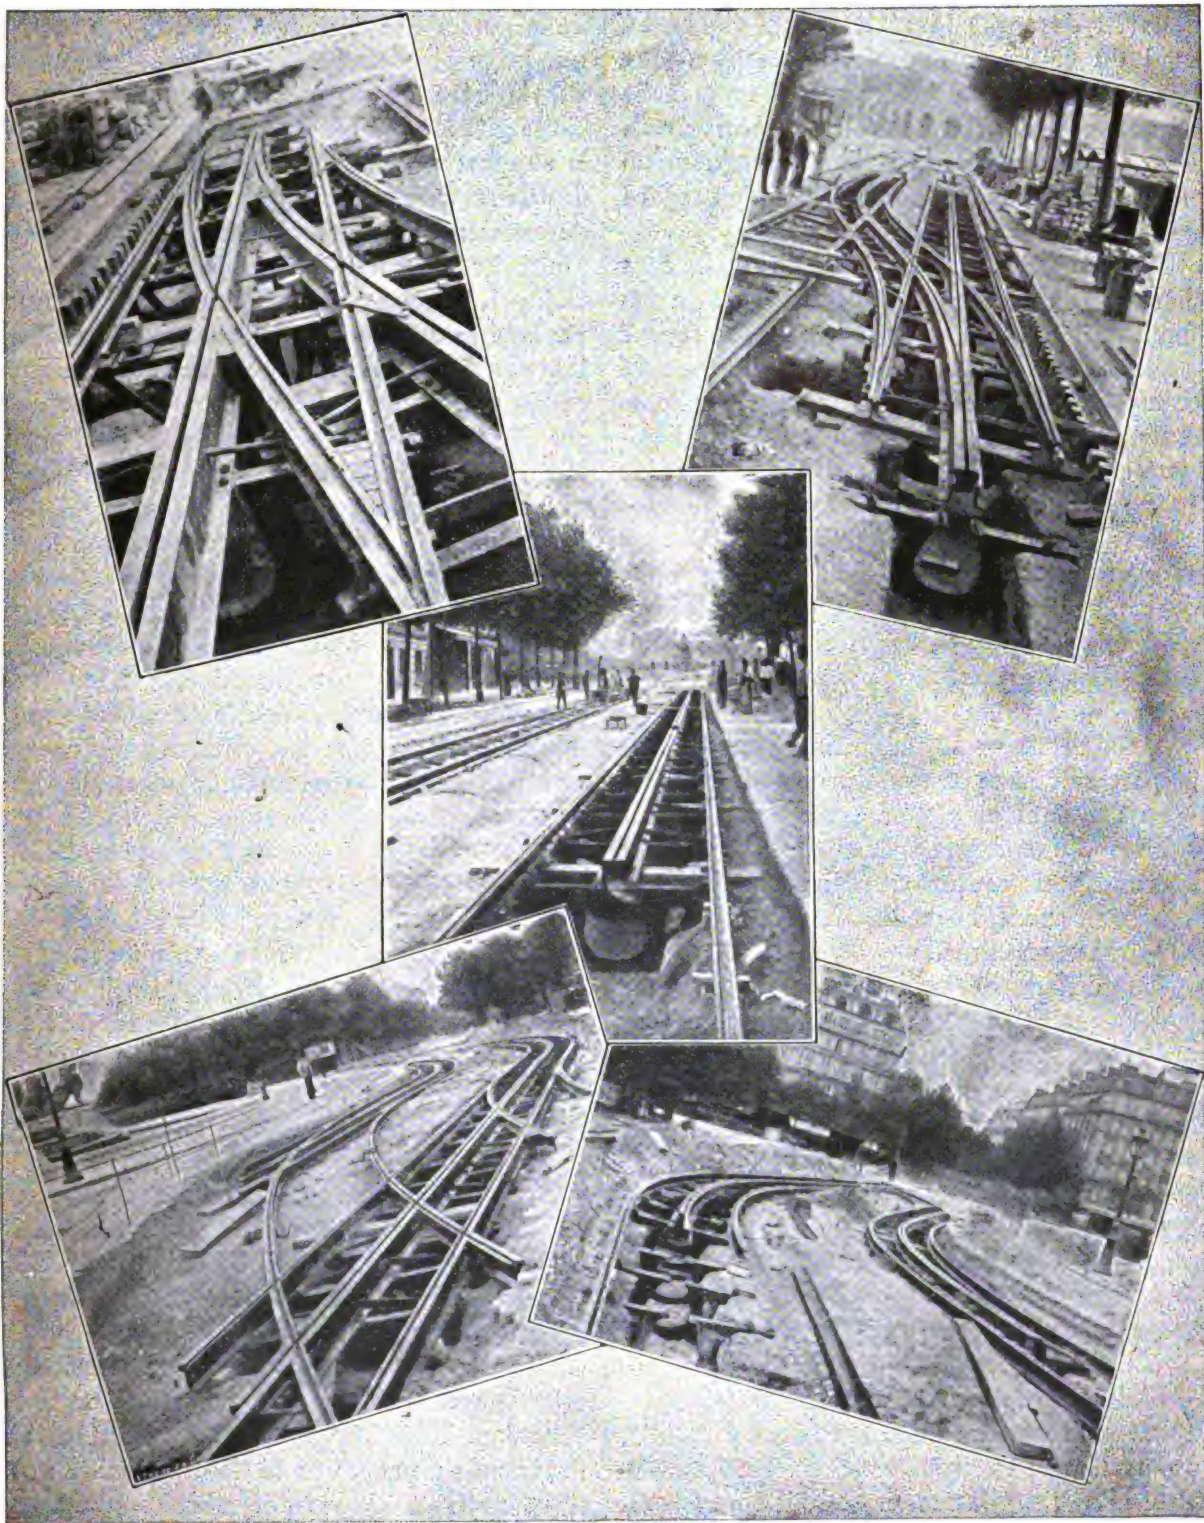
Voie en construction, avenue Daumesnil et place de la Bastille.
